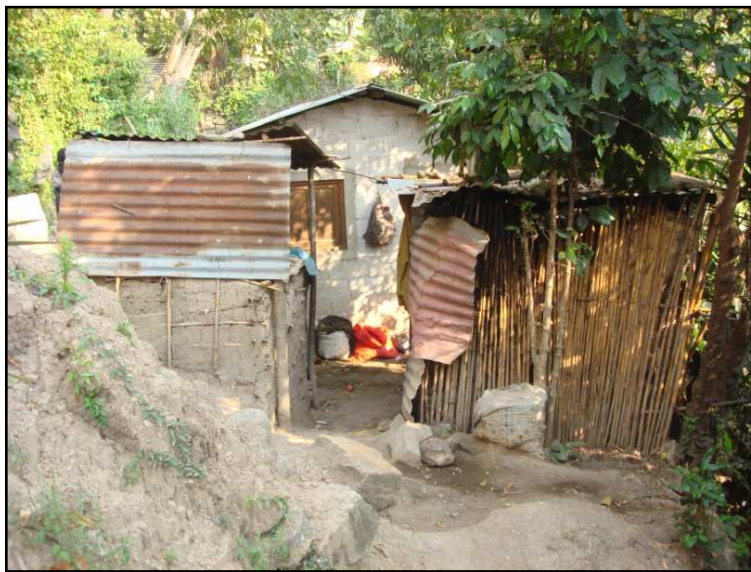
Tipo de vivienda de Santa Cruz La Laguna.
